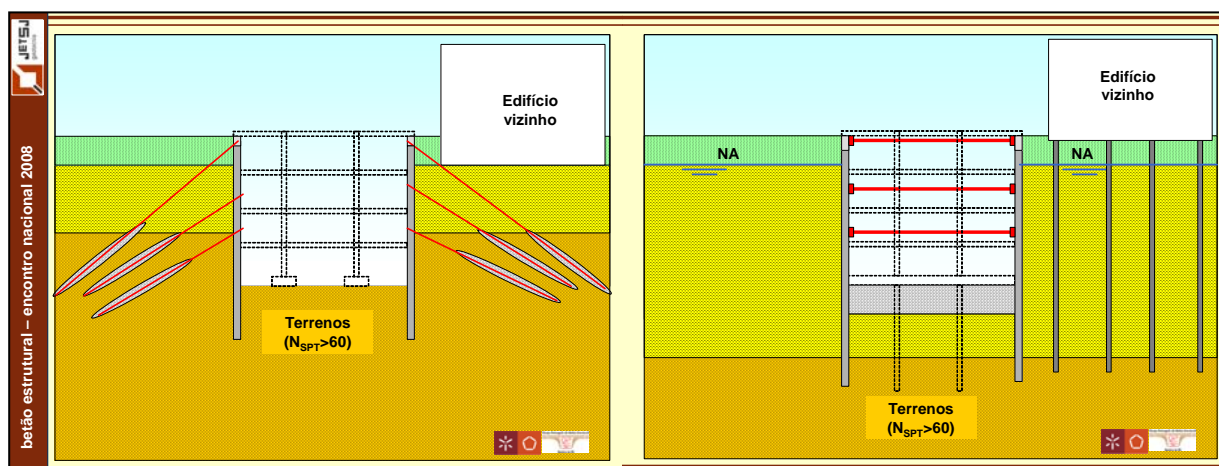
Secções tipo de soluções de travamento correntes por ancoragens e por escoramentos no menor vão da escavação.
